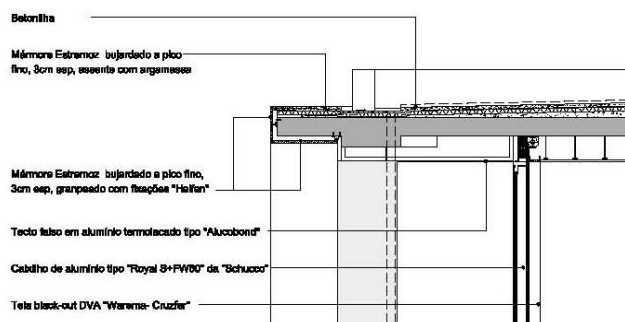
Pormenor construtivo da cobertura; Fonte: MAPEI/ Ordem dos Arquitectos
